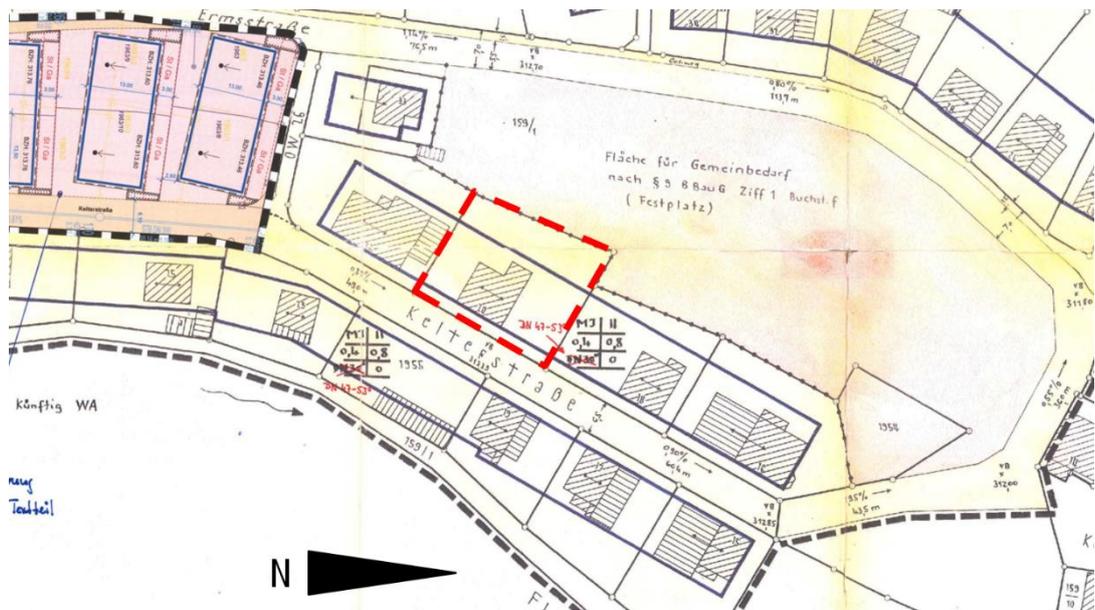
Bebauungsplan „Kelternauchtert, 6. Änderung“ von 2015, Plangebiet in Rot
